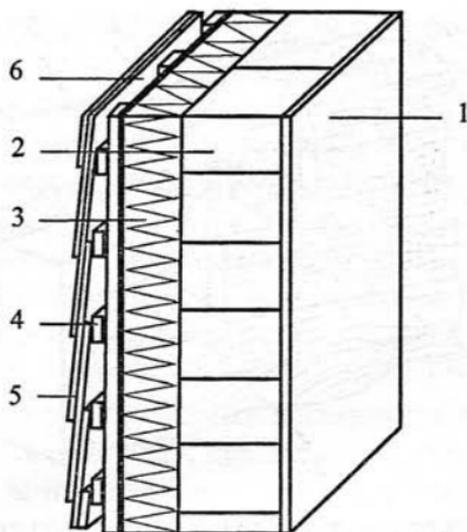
Конструкция фасада с внешней теплоизоляцией из стекловатных плит:
